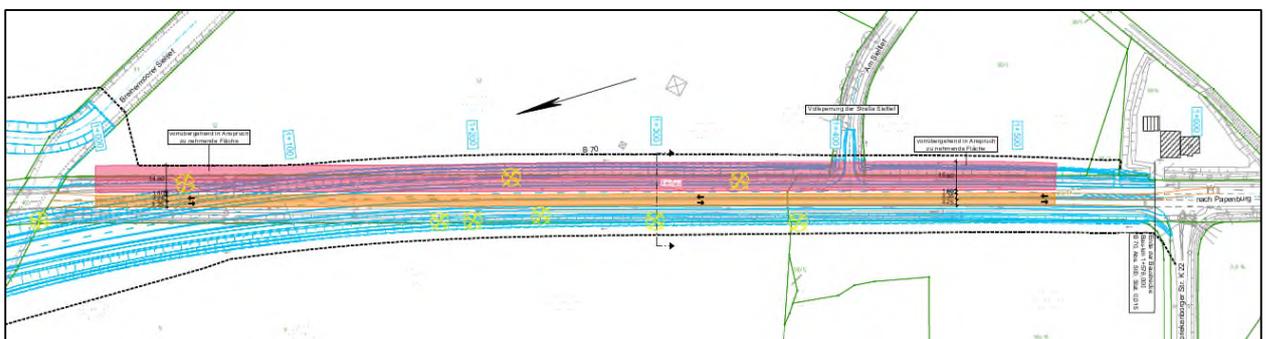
Lageplanausschnitt Bauphasenplan Süd, Bauphase D 1
